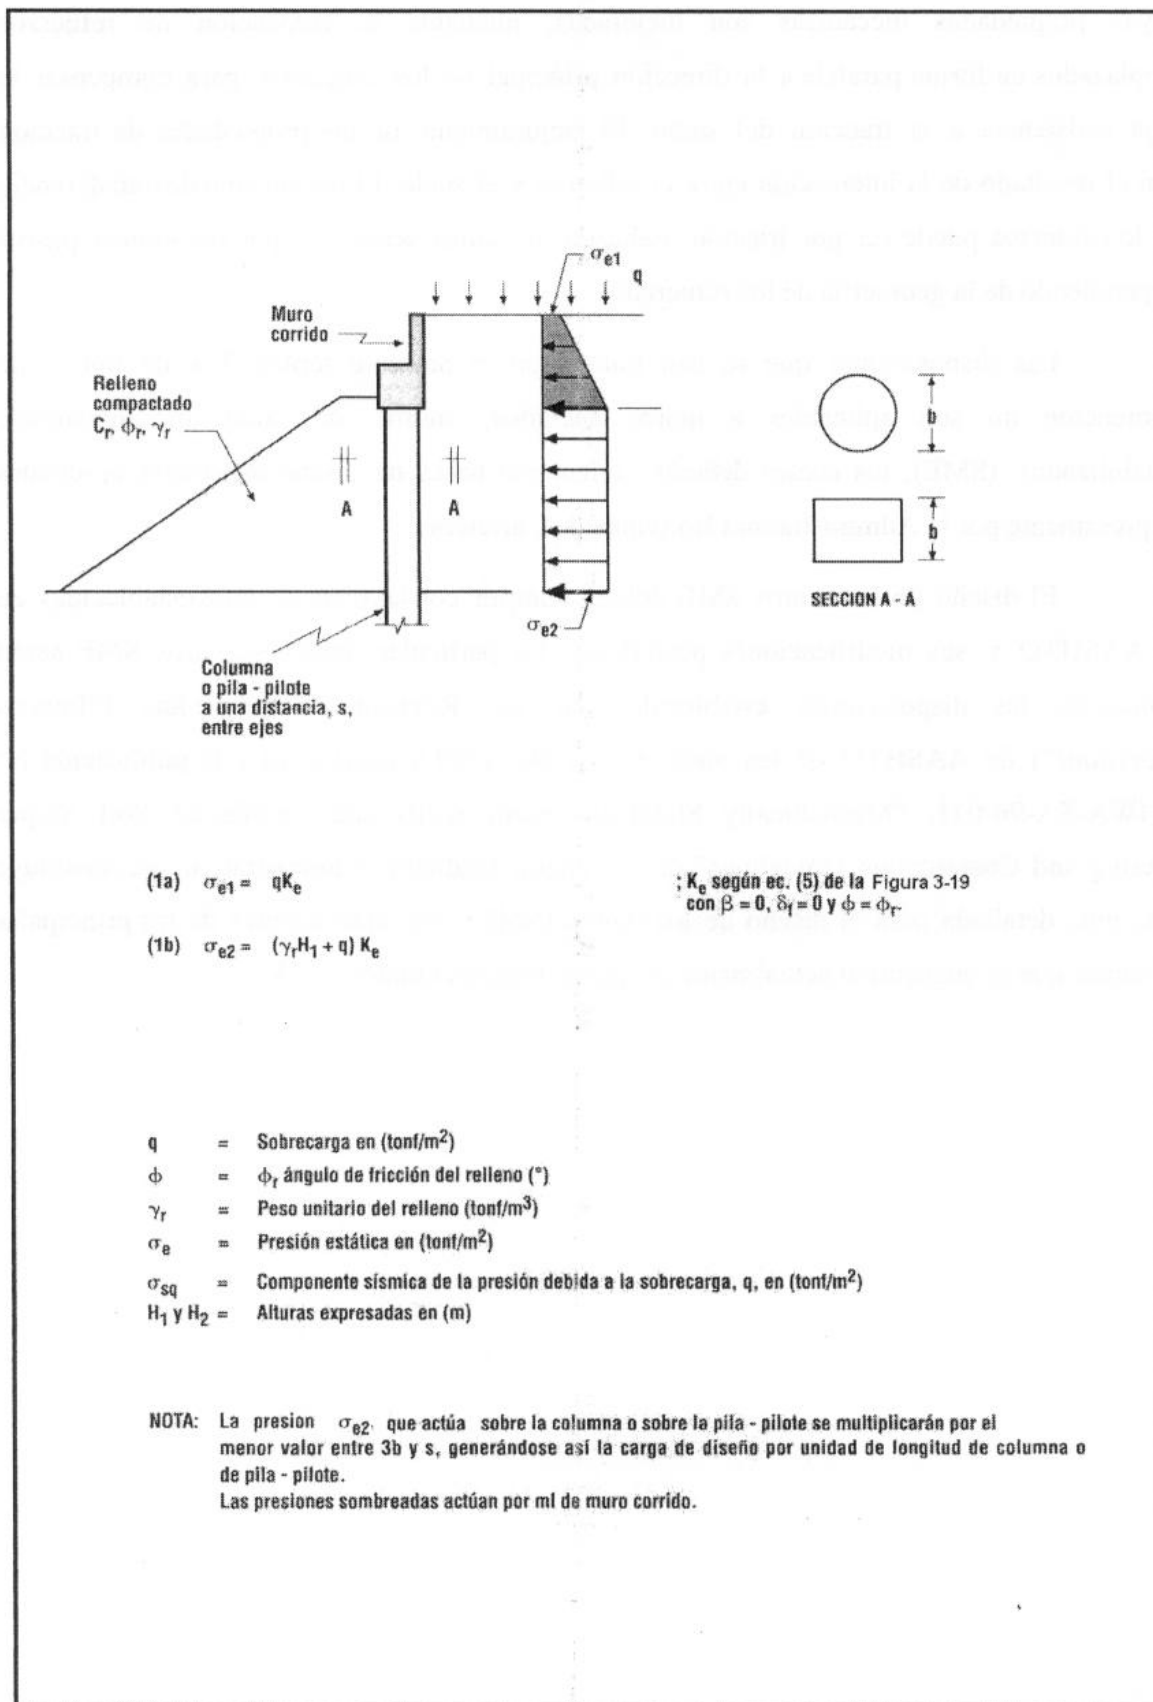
Empujes de tierra sobre estribos con columnas³
